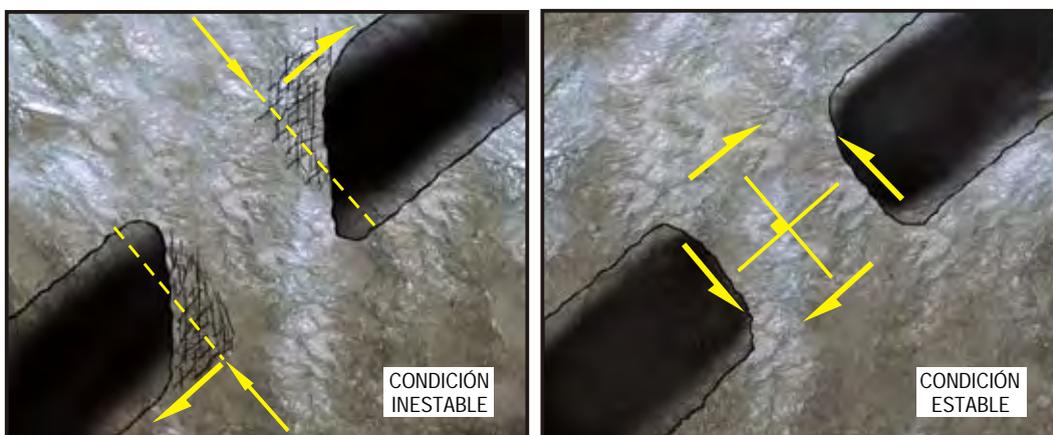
Pilar inestable (cargas de momento). Pilar estable (cargas de corte).
